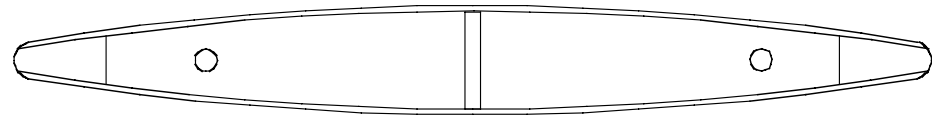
Querschnitt Holz-Lamelle mit Deckschicht aus Birkenperrholz (ohne Maßstab)
